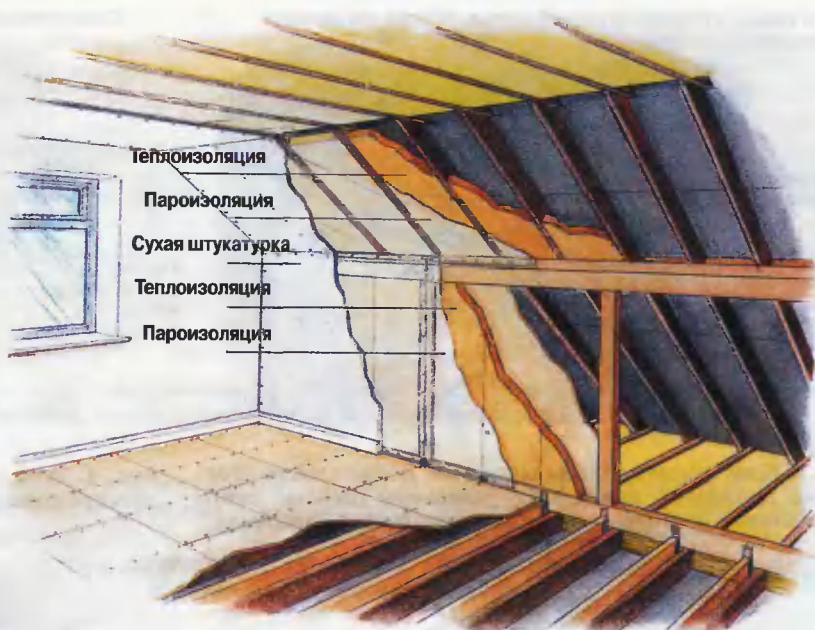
Если чердак будет использоваться как мастерская, то за счет установки теплоизоляции за стенами и потолком сформируется новое помещение мансарды. До монтажа теплоизоляции под полом сначала укладывают изоляцию в свесах
